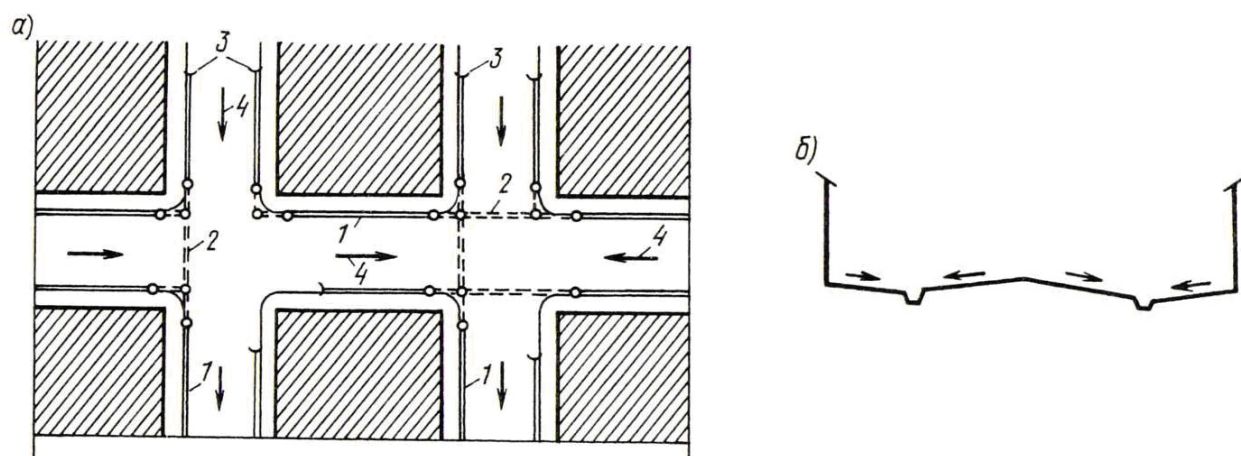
Відкрита система водовідведення: а) план; б) поперечний профіль вулиці з кюветами; 1 – кювети; 2 – труби; 3 – початок кювету; 4 – повздовжній профіль вулиці
